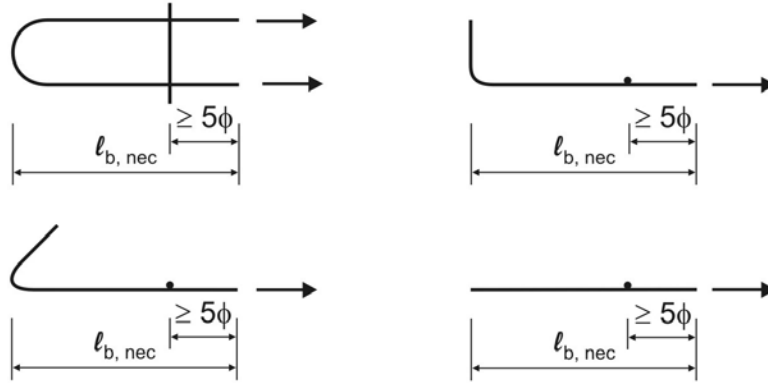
Ancoragem com barras transversais soldadas
